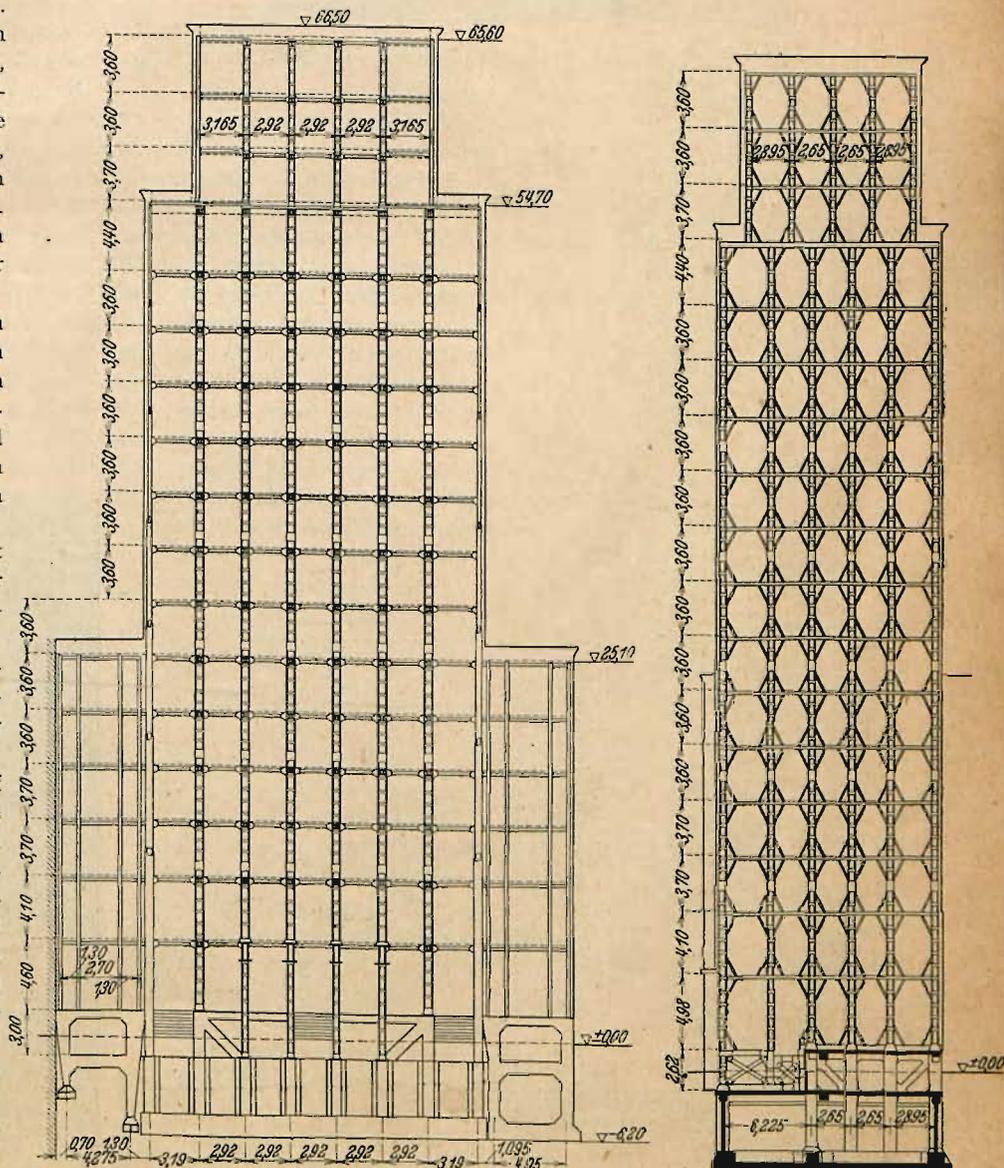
u. 8. Stahlkonstruktion des Turmes.
